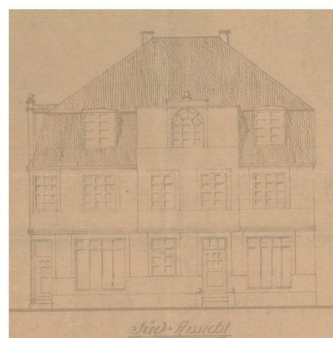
erster Entwurf Neubau der Löwenstr. 10
